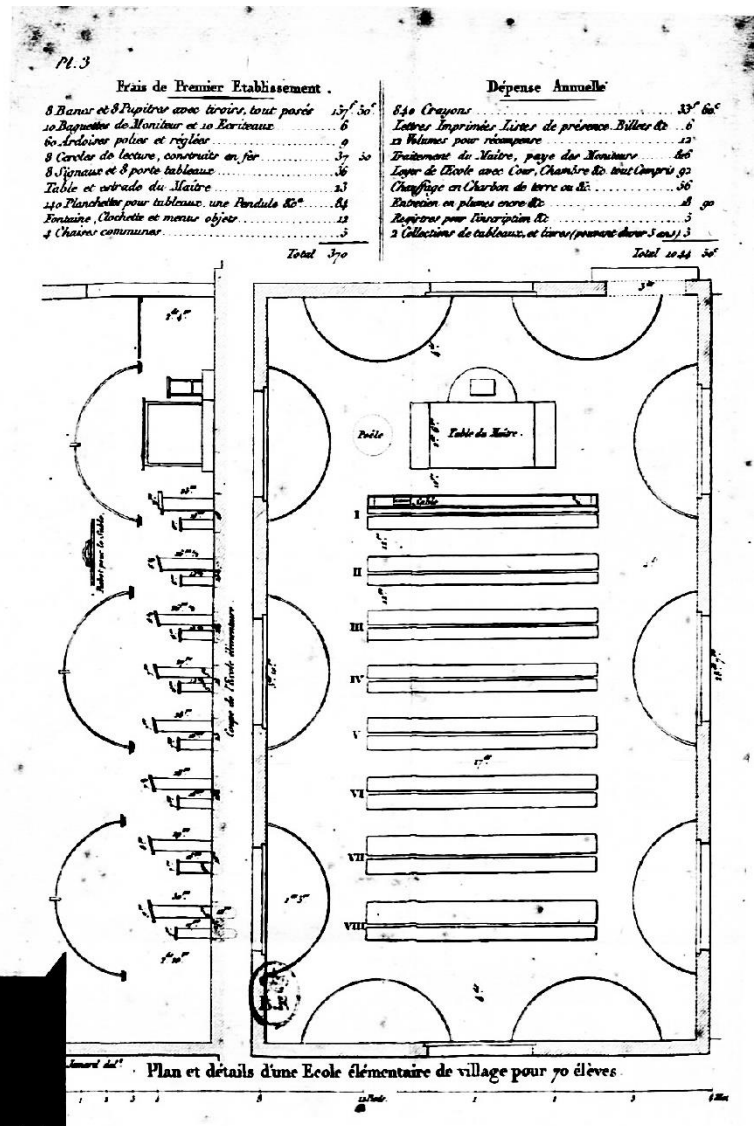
Plan et détails d'une École élémentaire de village pour 70 élèves.
